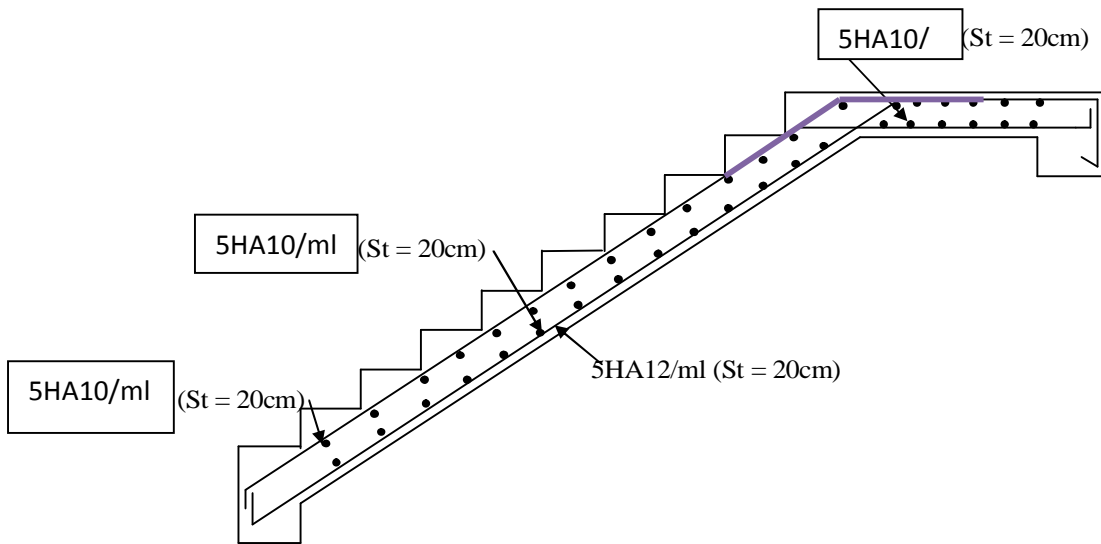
Schéma de ferrailage de l'escalier de l'étage courant
